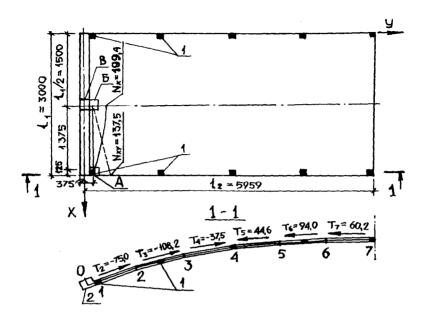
К определению нормальных и сдвигающих усилий в расчетных элементах А.Б и В толшение 1—закладная деталь; 2—приопорное утолшение
